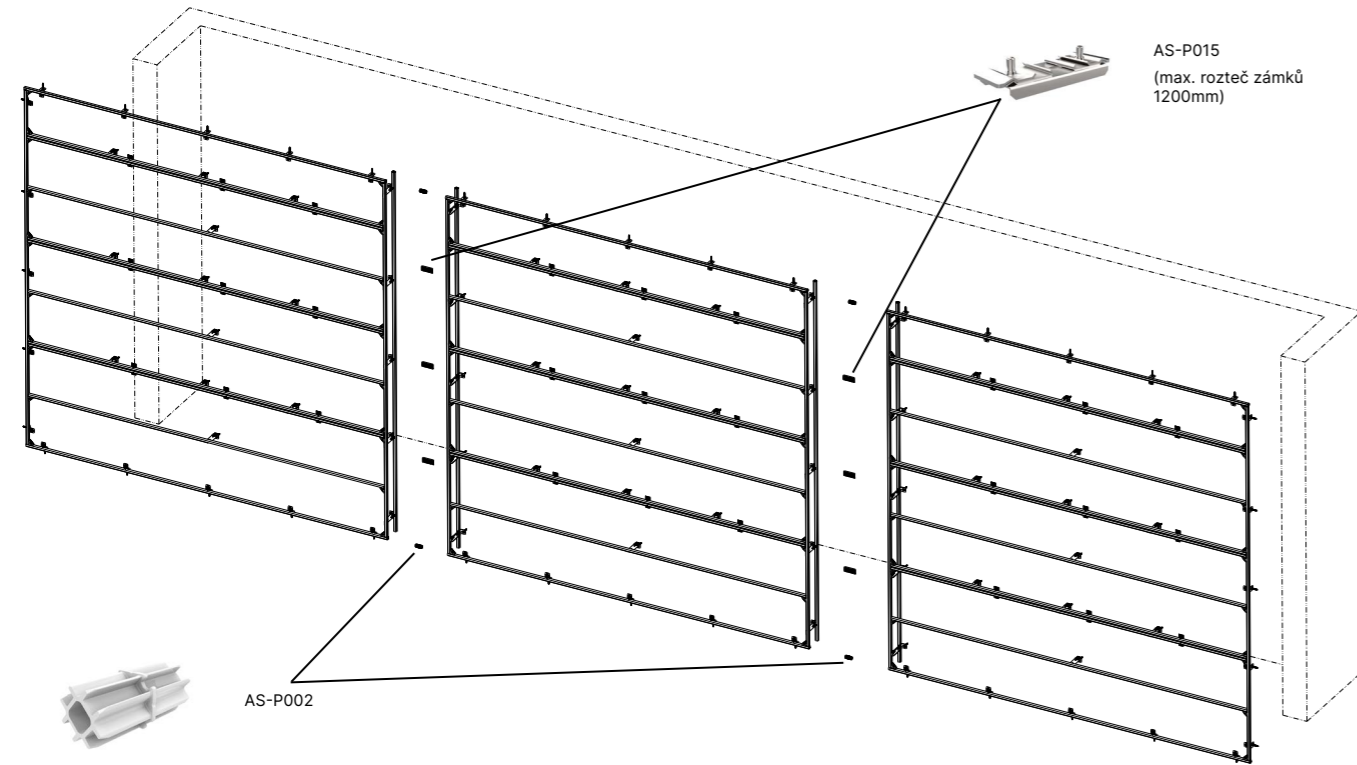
Konstrukce před nosnou zeď se šachtou – rozdílná tloušťka konstrukce šachty a předstěny
